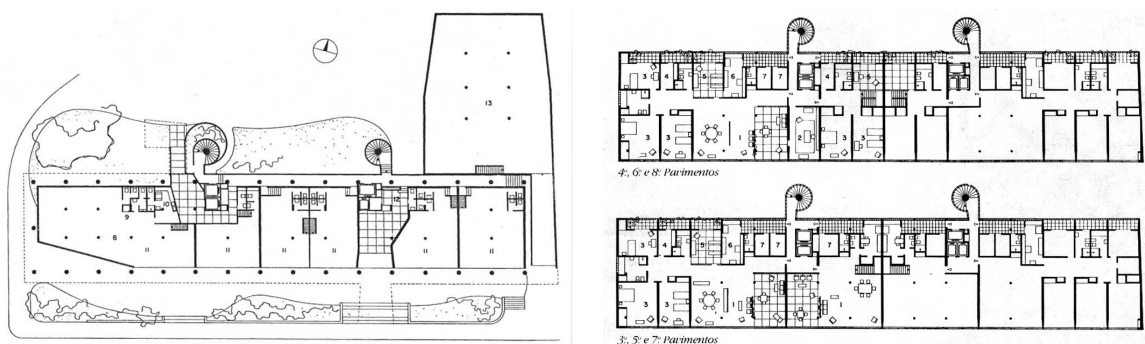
Parque Guinle, edifício Nova Cintra, plantas baixas do pavimento térreo (esquerda) e dos pavimentos elevados (direita).
